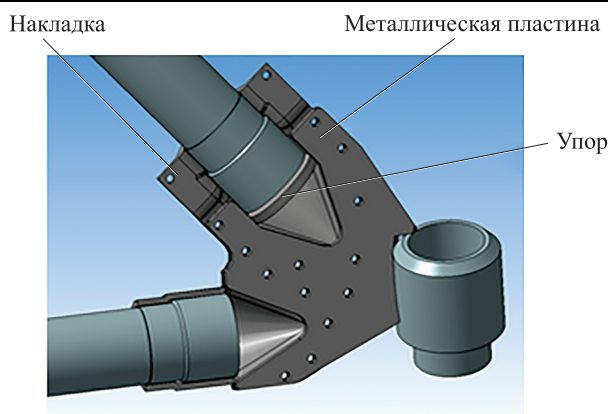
Соединение трубы и фитинга с использованием металлической пластины и металлического упора
